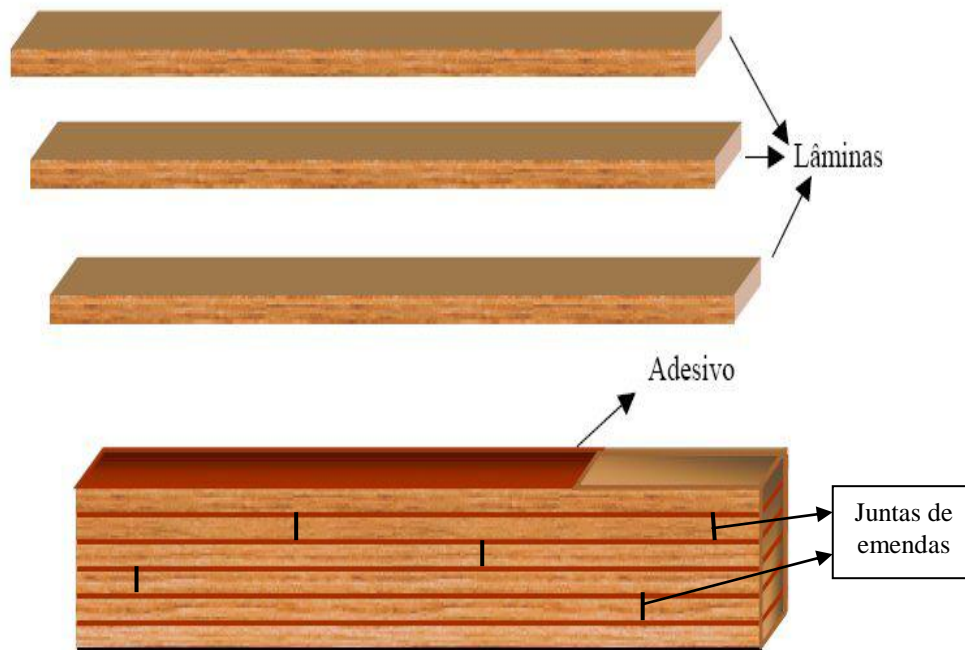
Montagem de uma viga de madeira laminada colada (MLC)
